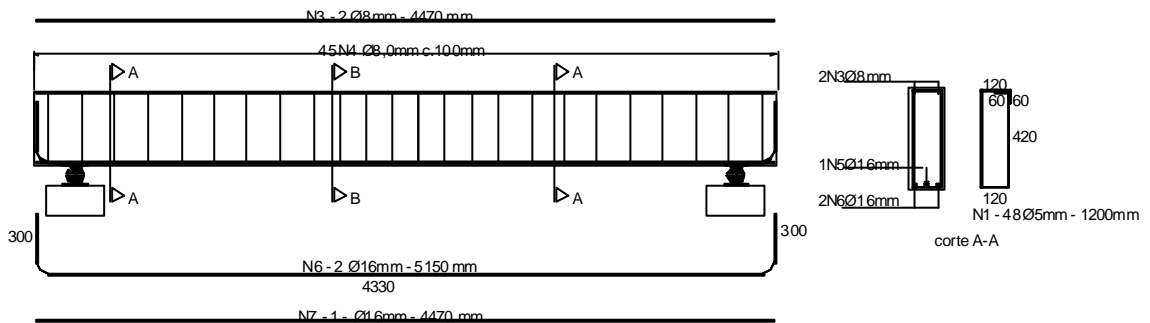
9 – Detalhamento da armadura interna da viga V1.
